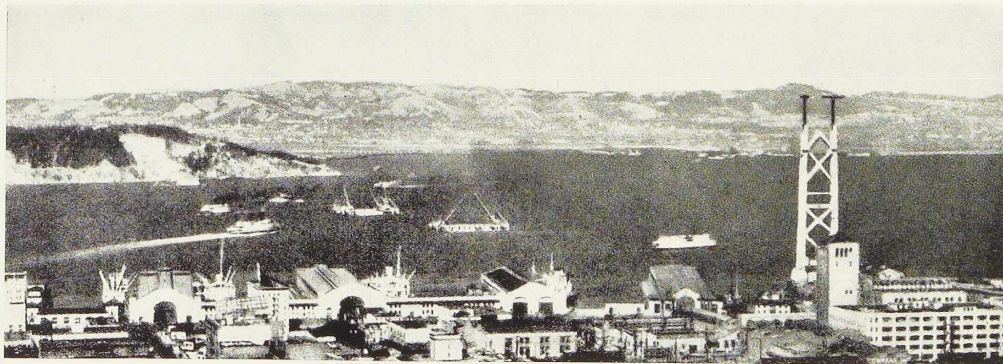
Vue générale des travaux du tronçon Ouest. Au second plan l'île Yerba Buena : dans le fond Oakland. Le portique n° 2 situé sur le quai n° 24 de San Francisco est en voie d'achèvement.
